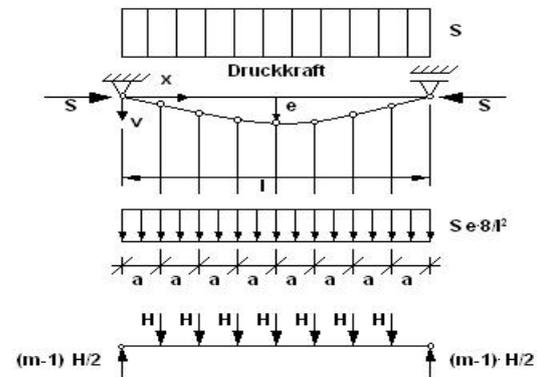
Stabilisierungslasten aus Fachwerkbindern
